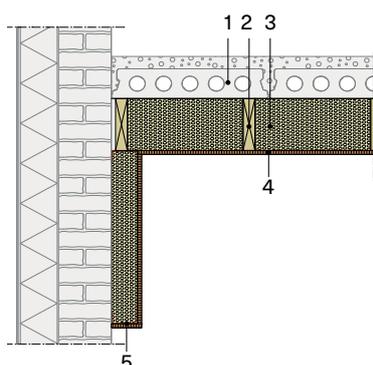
Isolation de la face inférieure du plancher et des murs à l'aide d'un isolant en vrac (vue 2D).
